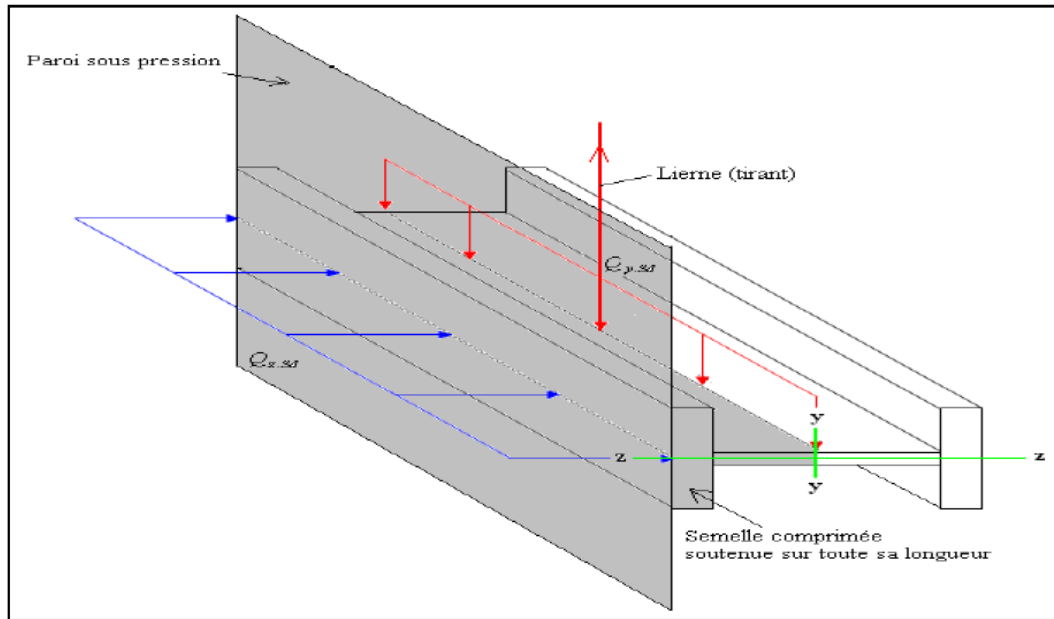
Semelle comprimée soutenue sur toute sa longueur
